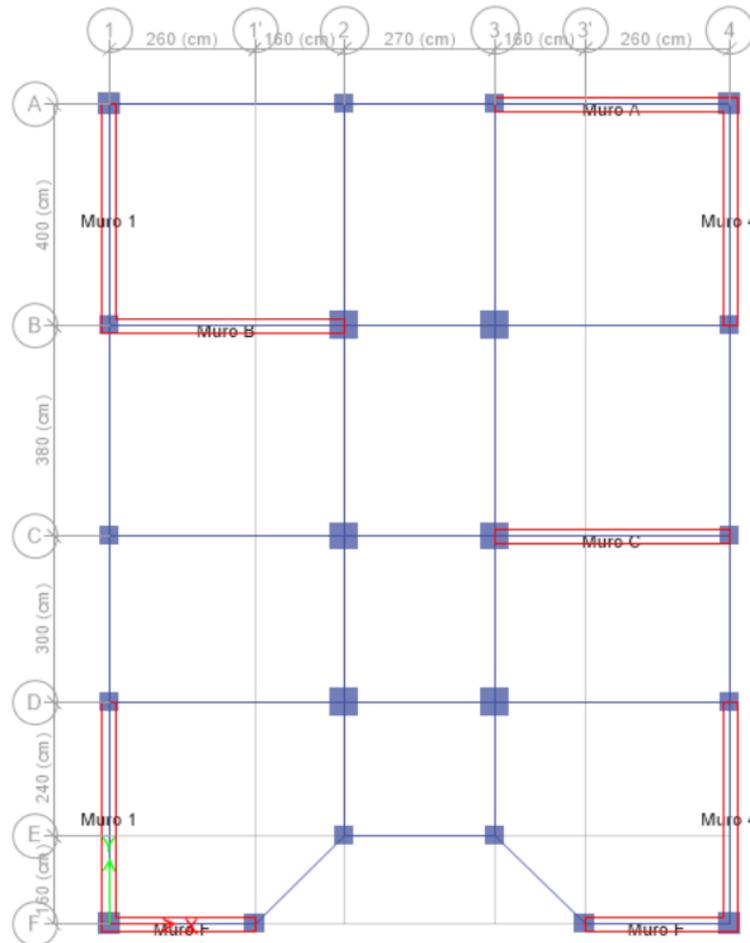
Propuesta de ubicación de la mampostería estructural. Vista en planta P1
